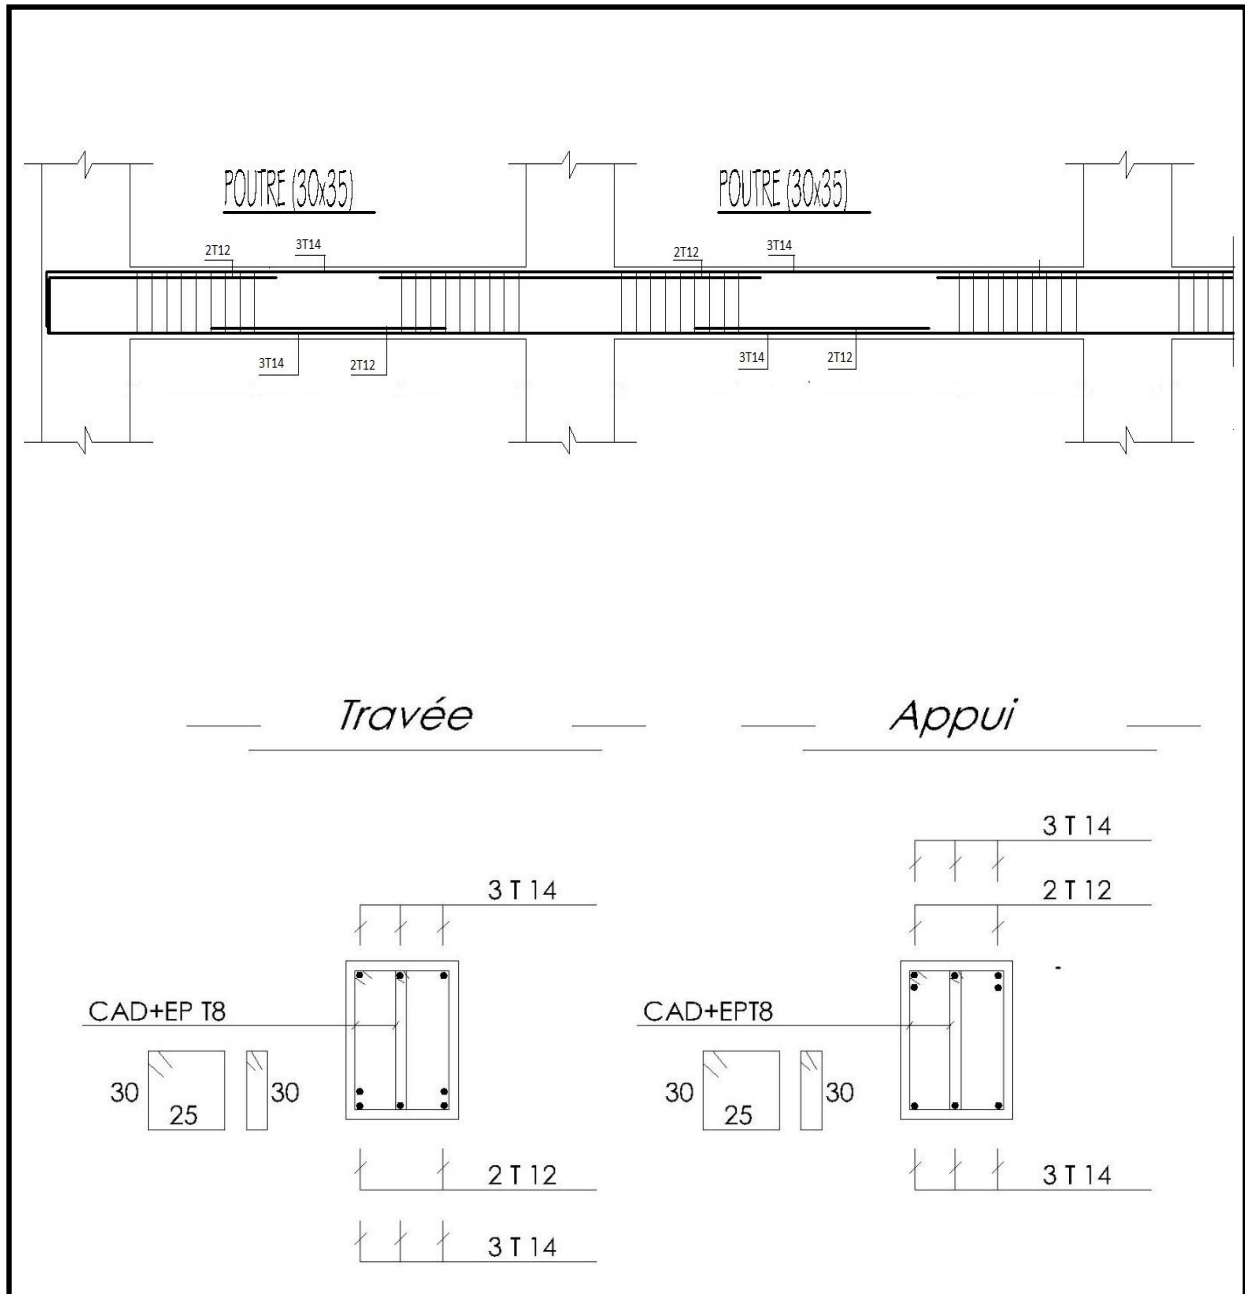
Ferrailage de la poutre secondaire (30x35):
